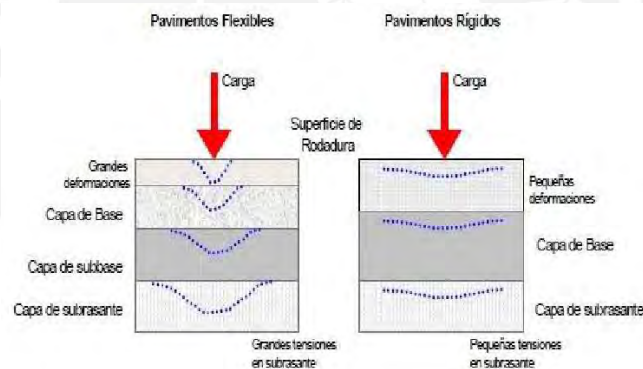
Esquema de comportamiento de pavimento rígido y flexible. Fuente Libro Pavimento (2018)
